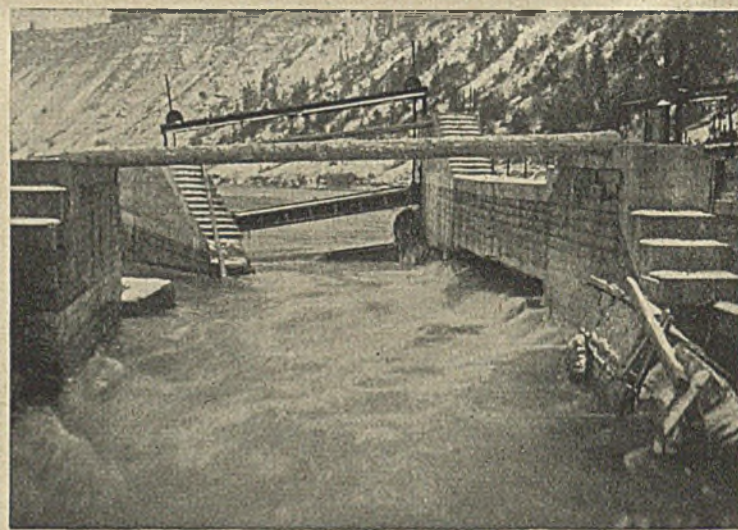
Einstürzende Bauwerksteile der alten Anlage.
